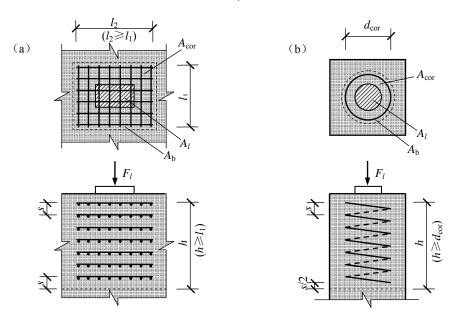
局部受压间接配筋 (a) 方格网配筋; (b) 螺旋配筋
